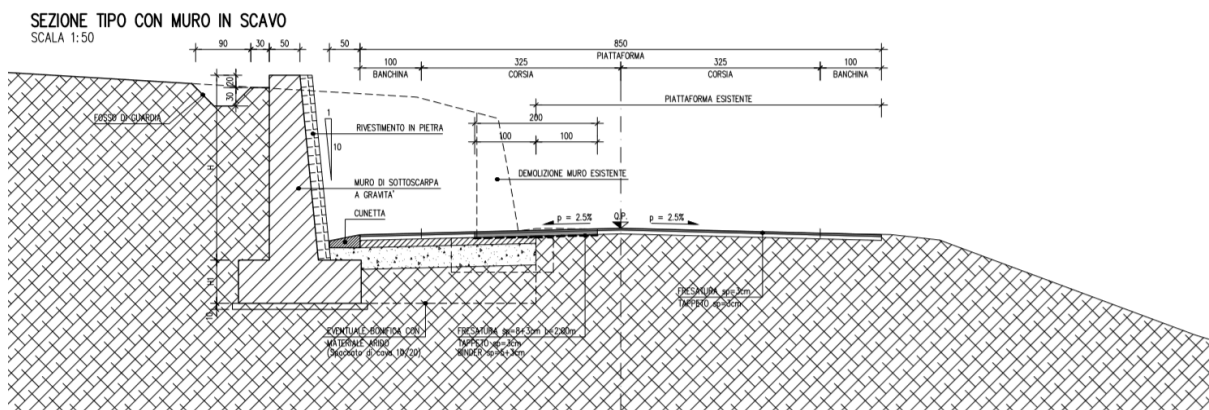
Sezione tipo in allargamento con muro di sottoscarpa
